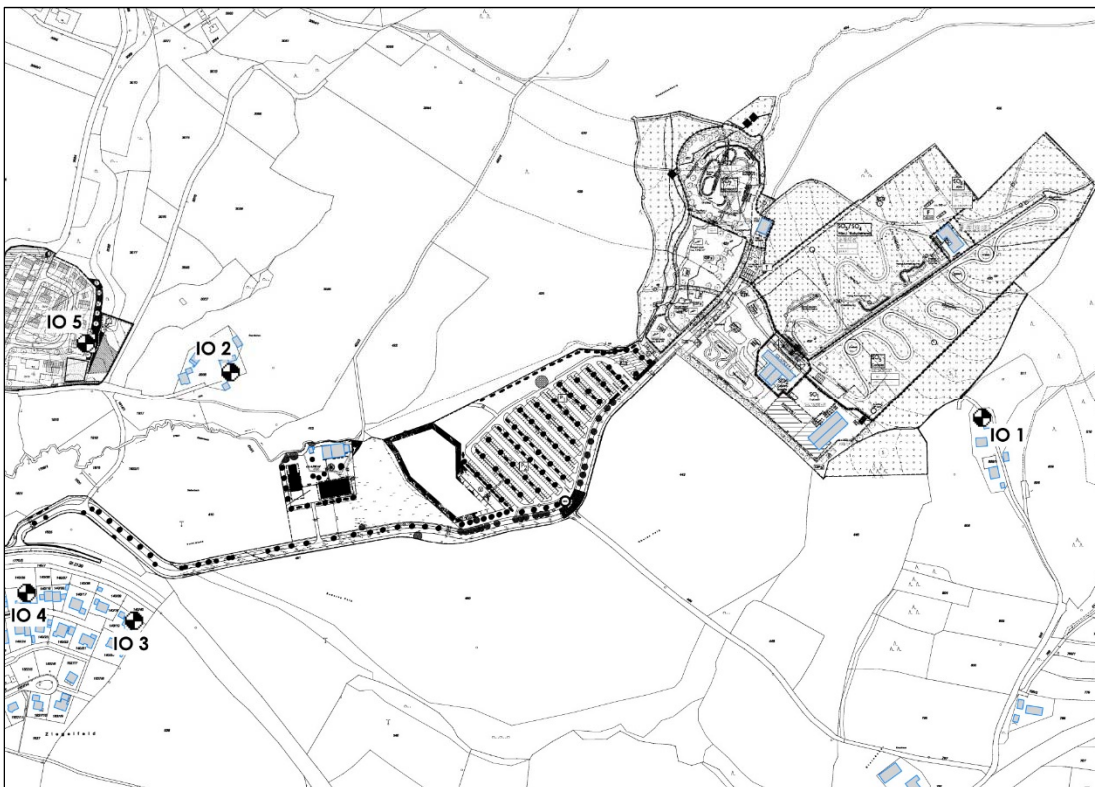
Lageplan mit Darstellung der maßgeblichen Immissionsorte
